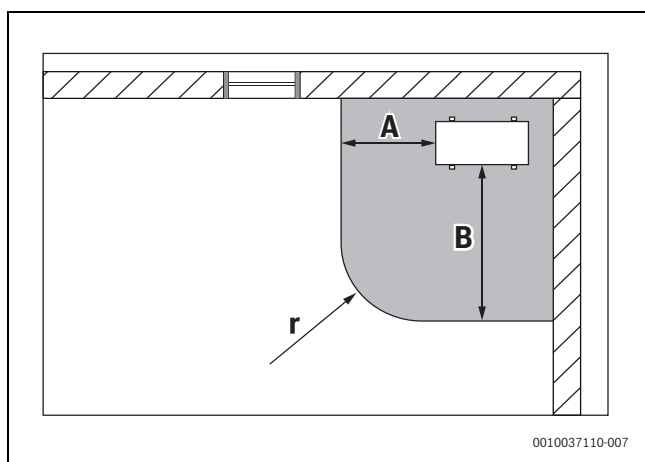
Schutzbereich bodenstehend in einer Ecke, Draufsicht
